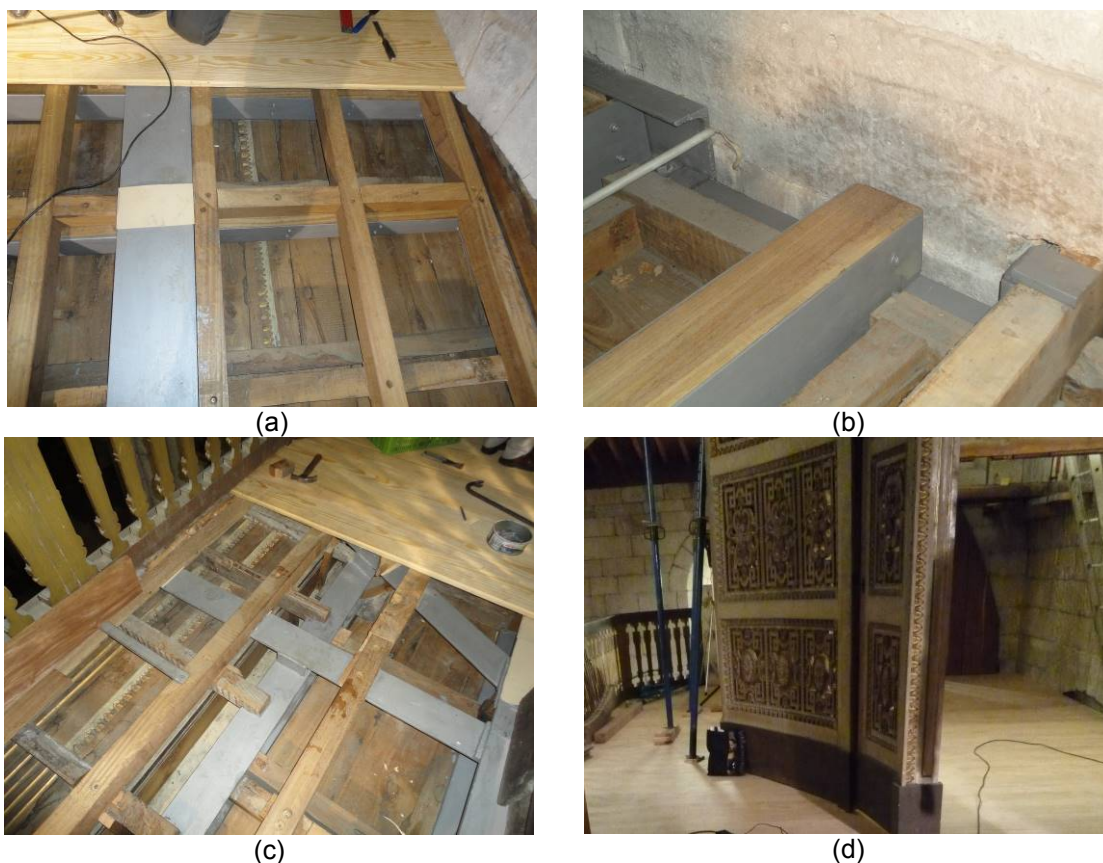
Pormenores da construção do pavimento do coro alto: (a) vigamento; (b) reforço da ligação entre a viga de madeira e a parede de alvenaria; (c) vigamento e reforço das ligações no pavimento em consola; (d) vista geral após aplicação do soalho.
